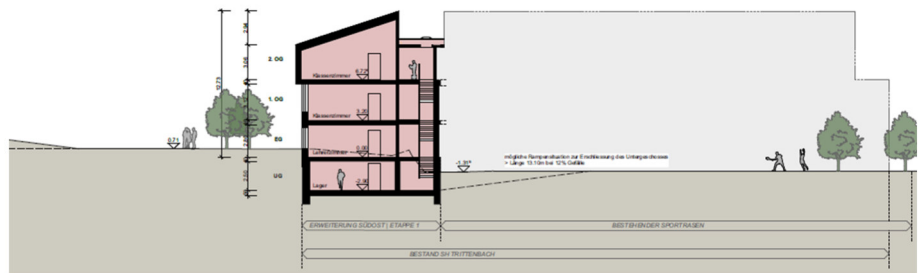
Disposition 1.2 | Gebäudeschnitt C-C
